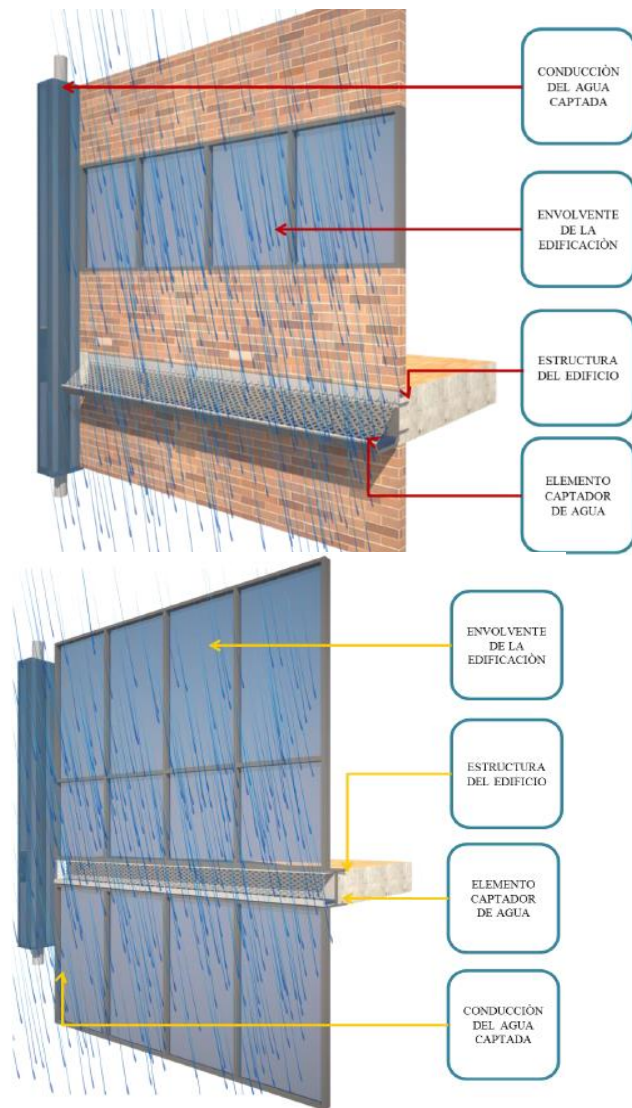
Modelo de captación de agua lluvia en fachadas de mampostería, ventanería y fachadas acristaladas.
